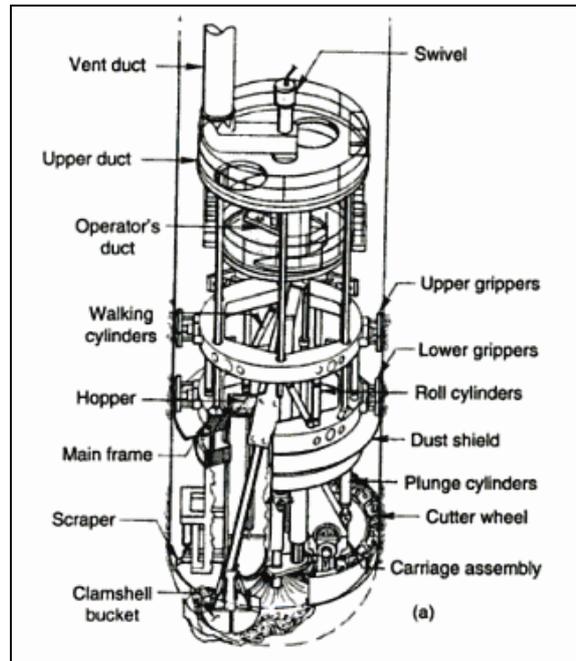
Diagrama de la máquina rotaria. (Fuente TAYITA, R. R., "Surface und Underground Excavations", Pág. 380).
